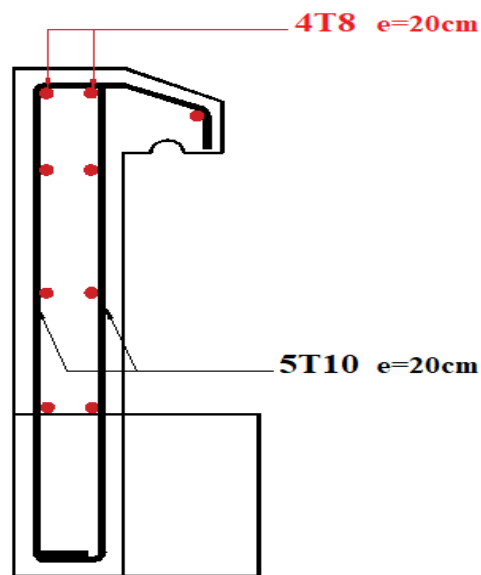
Dessin de ferrailage de l'acrotère.
